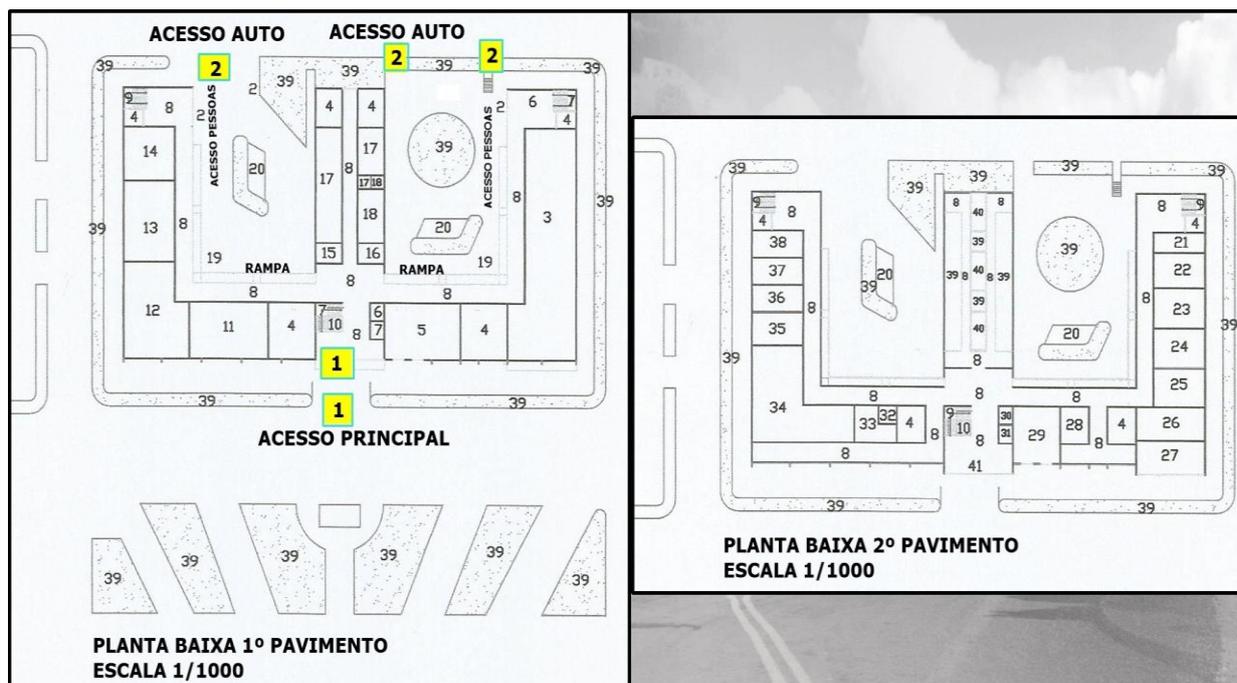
IMPLANTAÇÃO POR FUNÇÕES - 1º E 2º PAVIMENTOS
